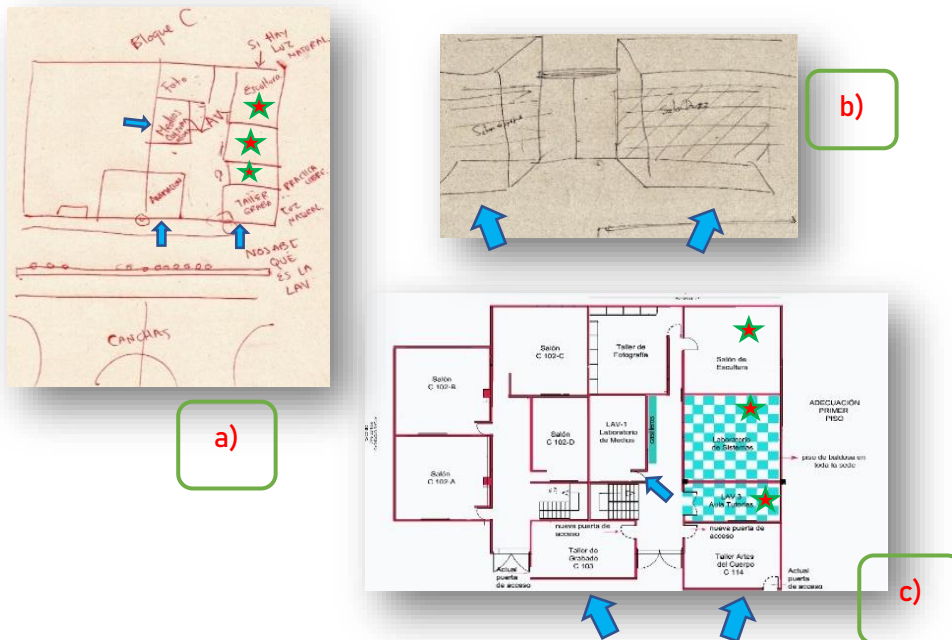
, planos primera planta, a) plano SJ; b) plano EB, C) plano LAV adecuación infraestructura de la LAV.
